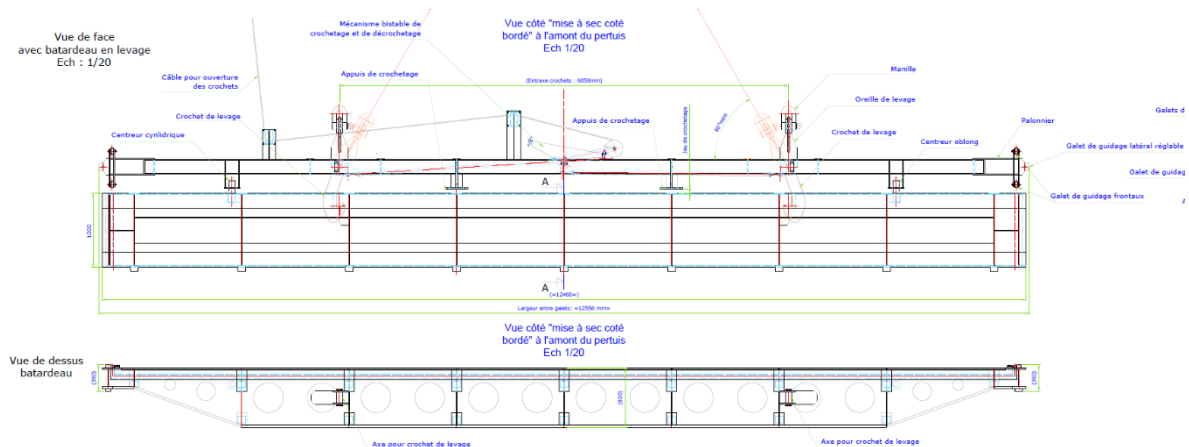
Vue de face et de dessus d'une poutre et du palonnier
